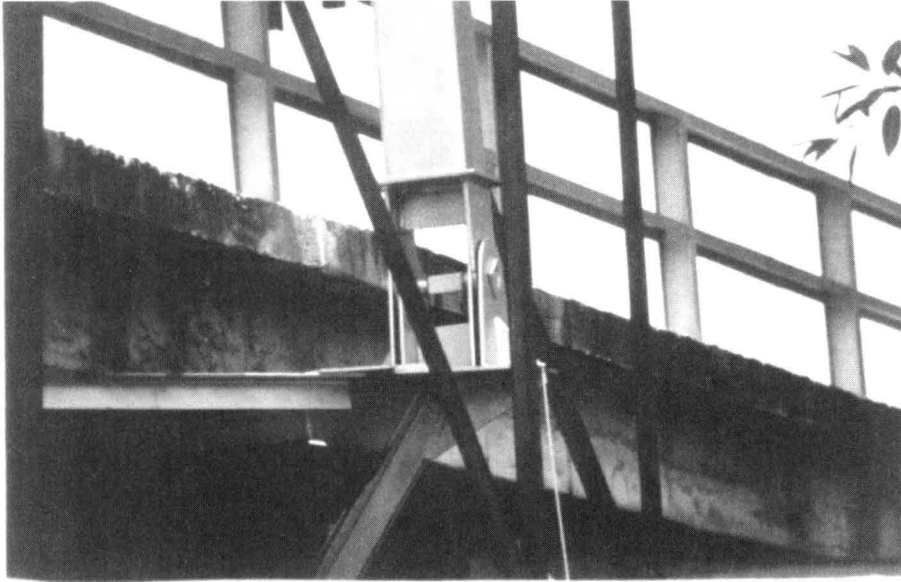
Puente del Opón. Detalle de la unión de las armaduras transversales con los pendolones.
